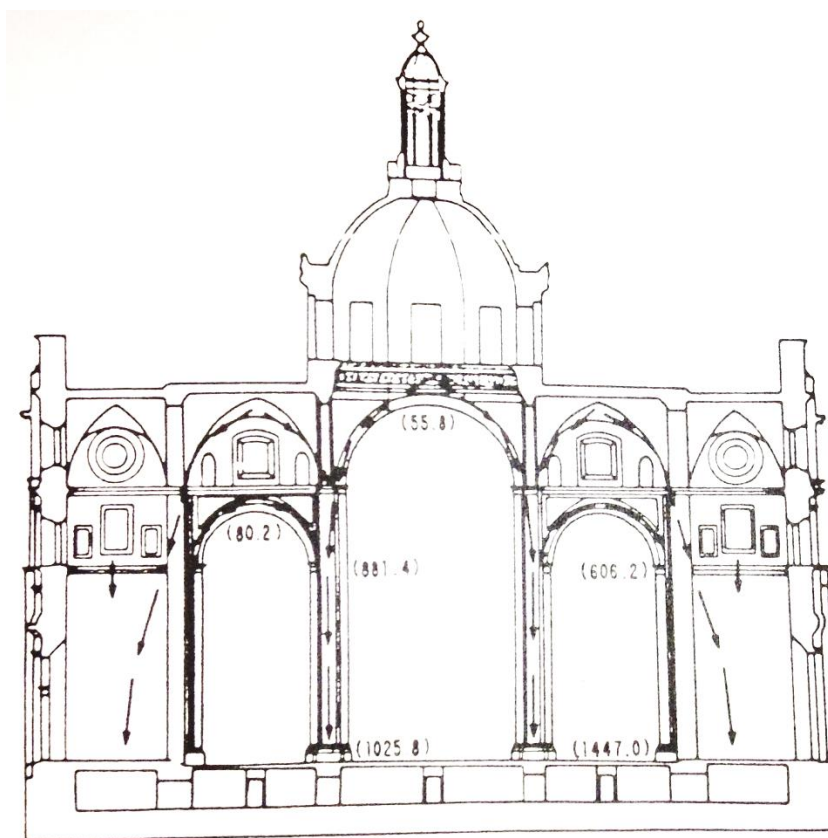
Trayectoria de las cargas de la cubierta sobre los muros (Meli y Sánchez, 1993)
